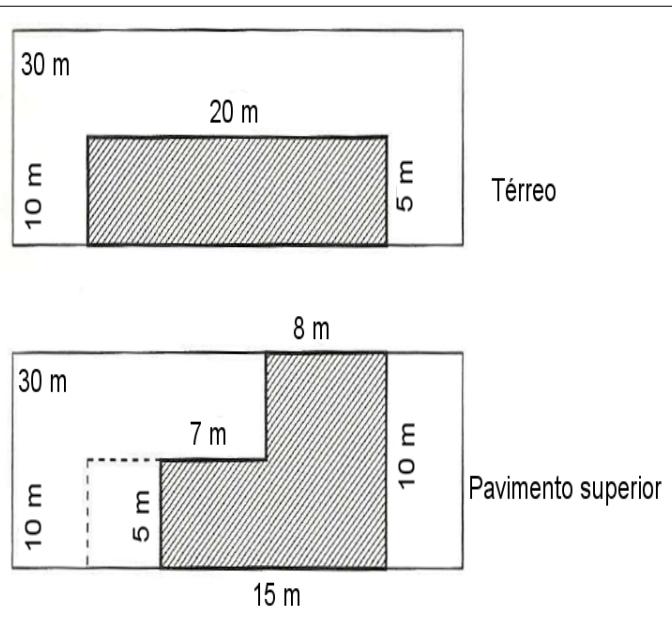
Planta de um terreno de 10 m x 30 m com a projeção de dois pavimentos a serem construídos. In: BORGES, Alberto de Campos. *Prática das pequenas construções*. V.1. 9.ed. São Paulo: Edgard Blucher, 2009. p. 23. (Adaptado).
